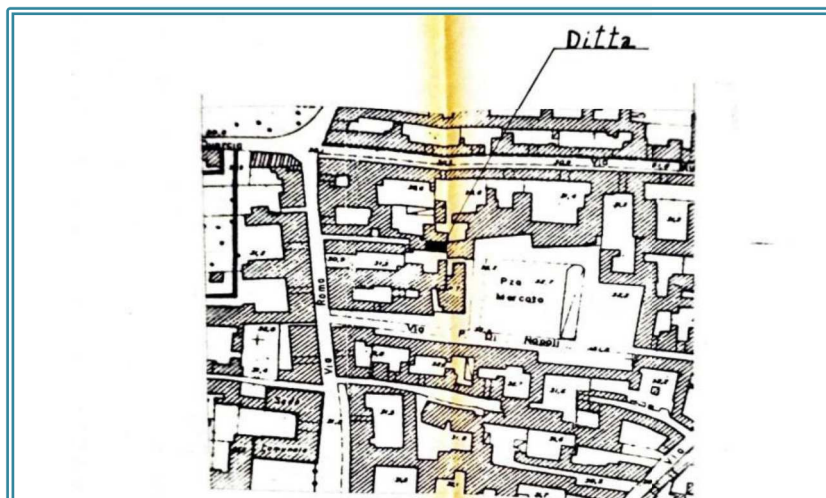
Planimetria inquadramento – estratto dal fascicolo pratica di costruzione edile n. 5951 del 17.03.1988
